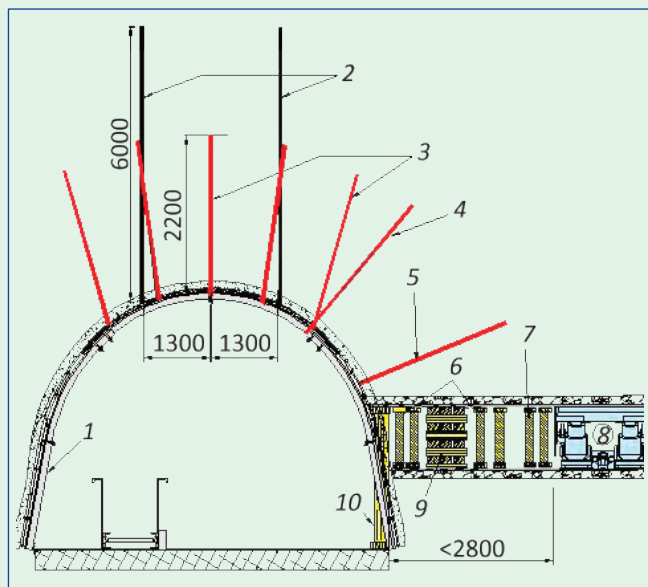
Паспорт крепления 165-го сборного штрека: 1 – крепь КШПУ 17,7; 2 – канатные анкера устанавливаются спарено с шагом 1,4 м; 3 – штанговые сталеполимерные анкера; 4 – боковой анкер для поддержания верхняка; 5 – анкер для поддержания кровли; 6 – стойка в плоскости рамы; 7 – обрезной ряд; 8 – комплекс DVT; 9 – накатный костер; 10 – боковая стойка диаметром 180 – 200 мм.
